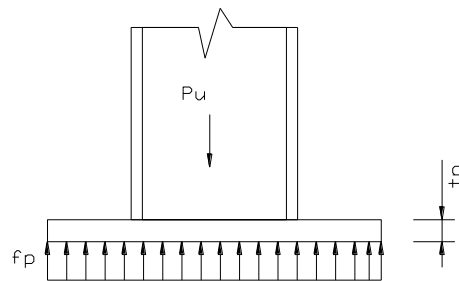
(a) Tensión de Aplastamiento Asumido
